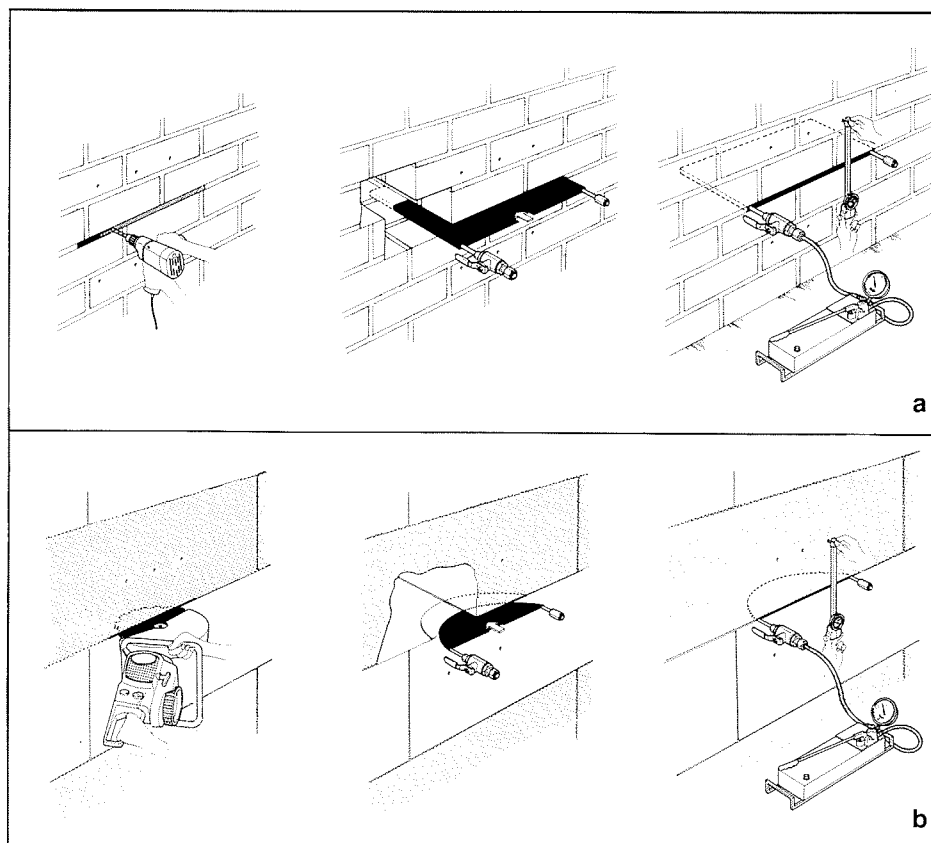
a) Prova con martinetto piatto rettangolare per la misura dello stato di sollecitazione di una muratura in laterizio.
